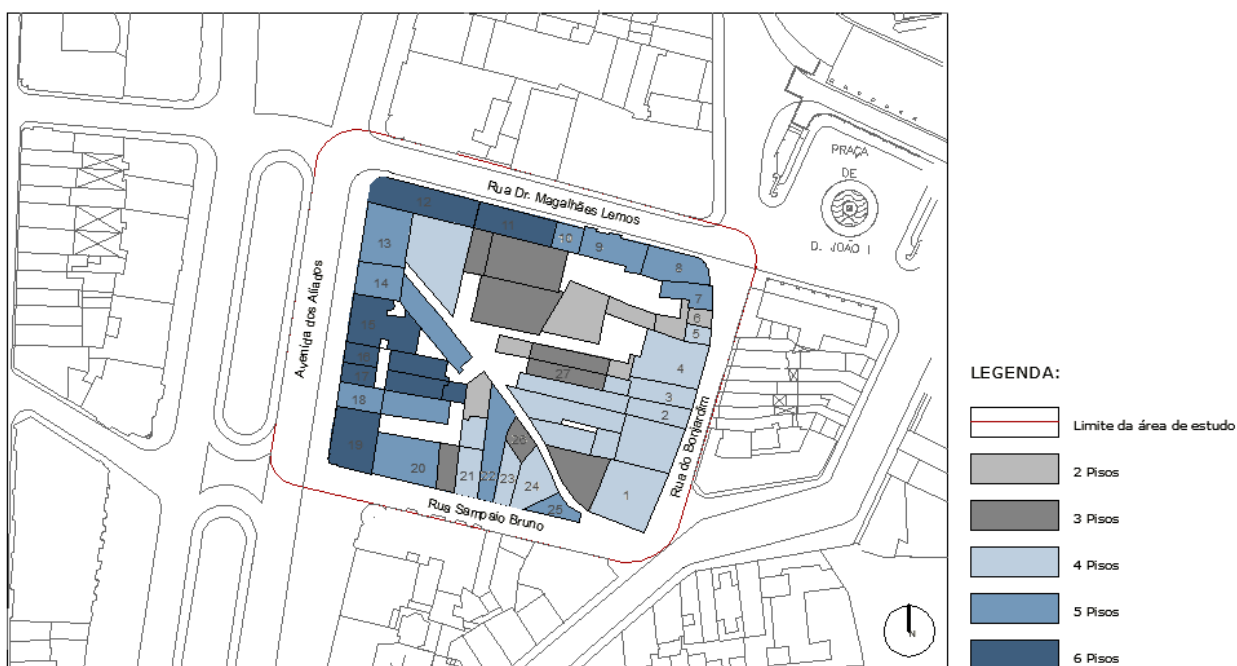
Planta da distribuição do número de pisos. Fonte: Autor.
